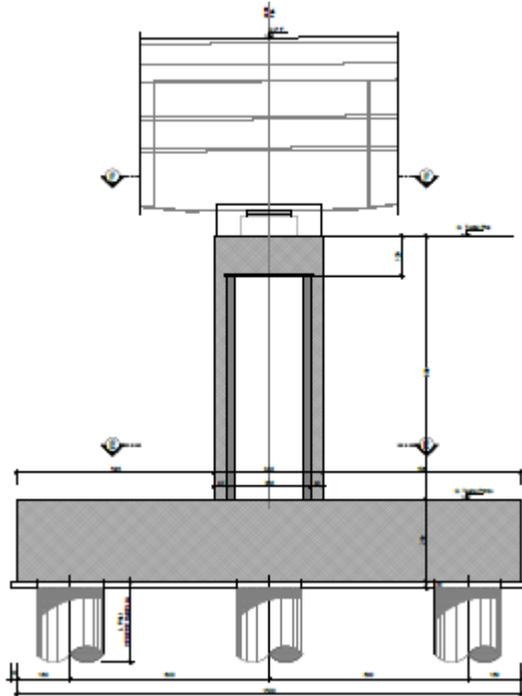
Sezione in direzione longitudinale rispetto all'asse del viadotto
